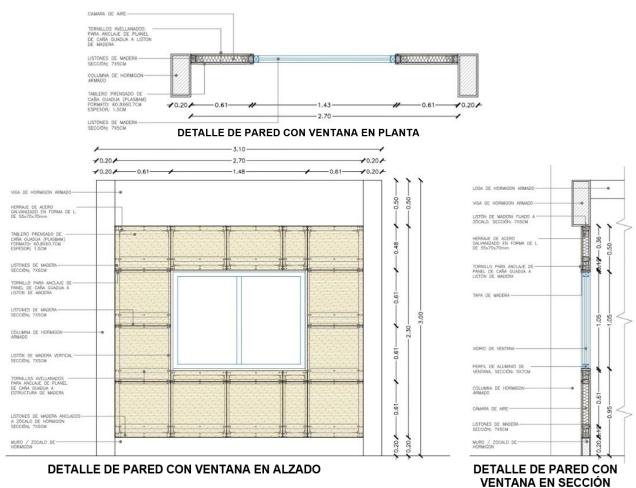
Detalle de pared con paneles prefabricados de caña guadúa
